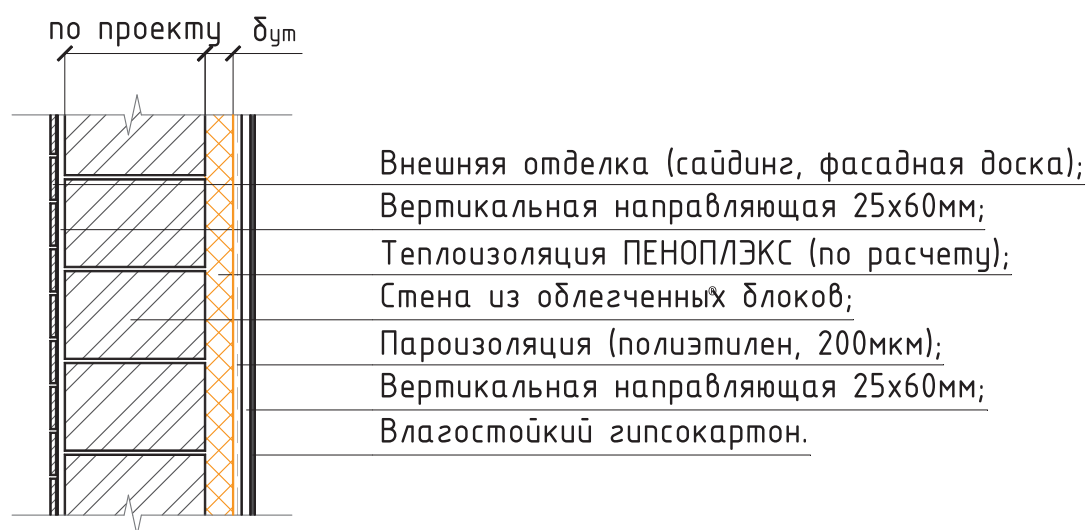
Схема внутреннего утепления стен из облегченных блоков.
